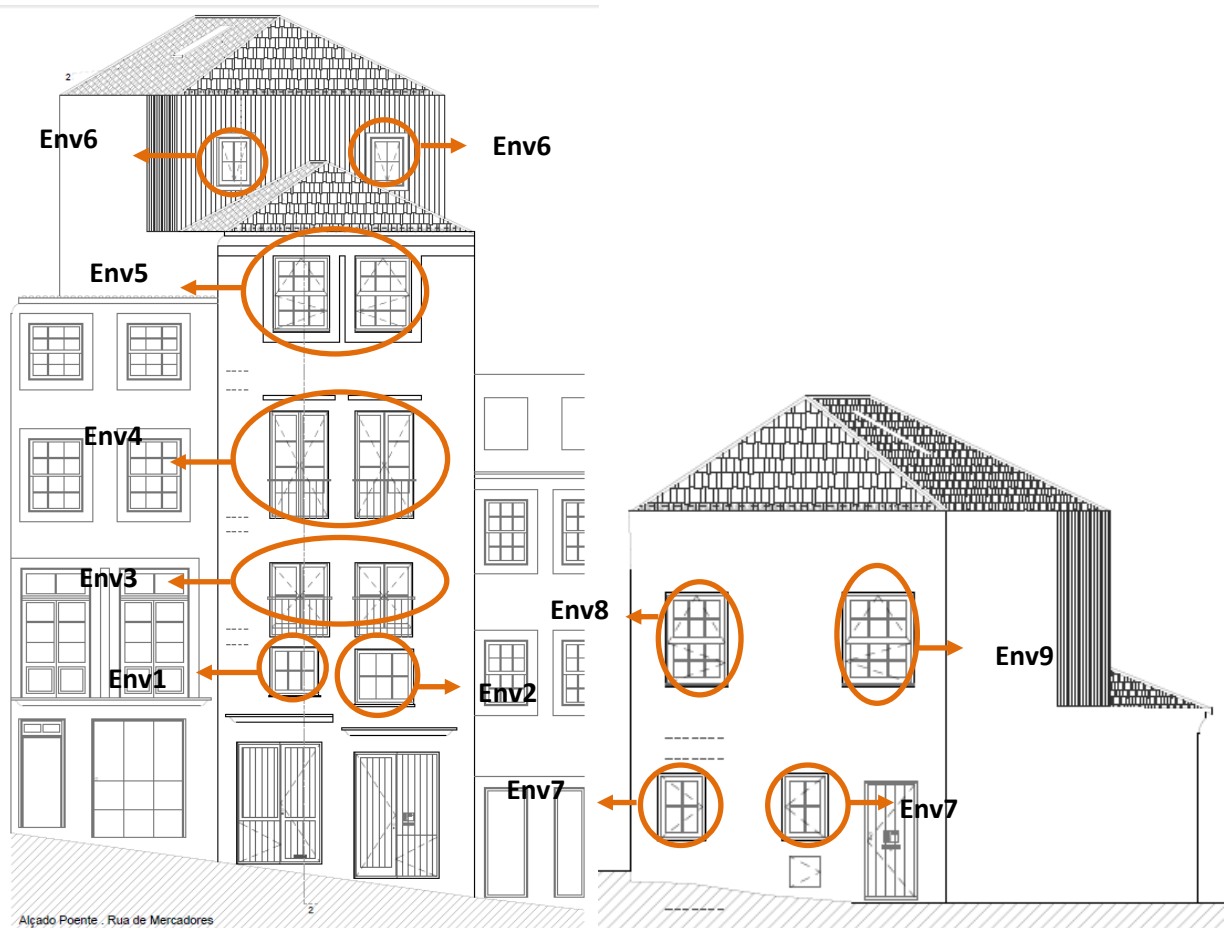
Envidraçados na fachada principal e de tardoz [17]
